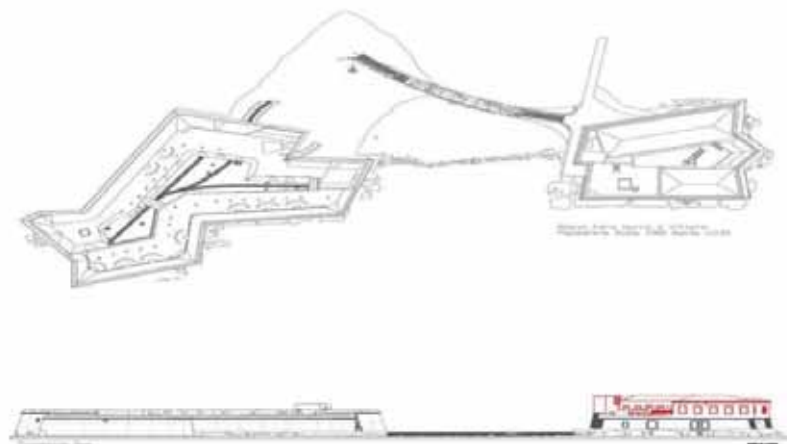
Pianta piano copertura e prospetti sud dei forti Garcia (a sinistra) e Vittoria (a destra). La parte disegnata in rosso indica la sopraelevazione risalente al XIX secolo. Rilievi dell'autore
